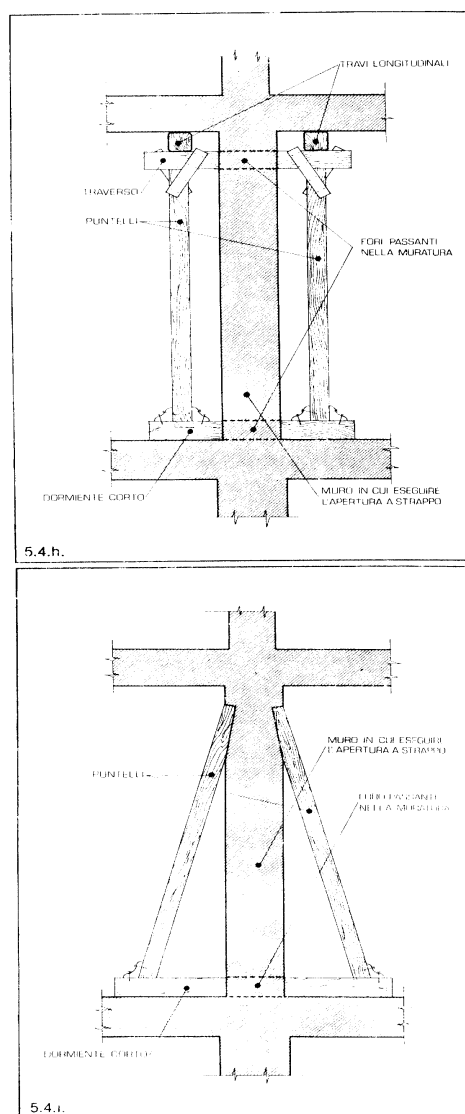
h. e 5.4.i. - Tipi di puntellamento per l'esecuzione di un'apertura a strappo in un piano elevato.
